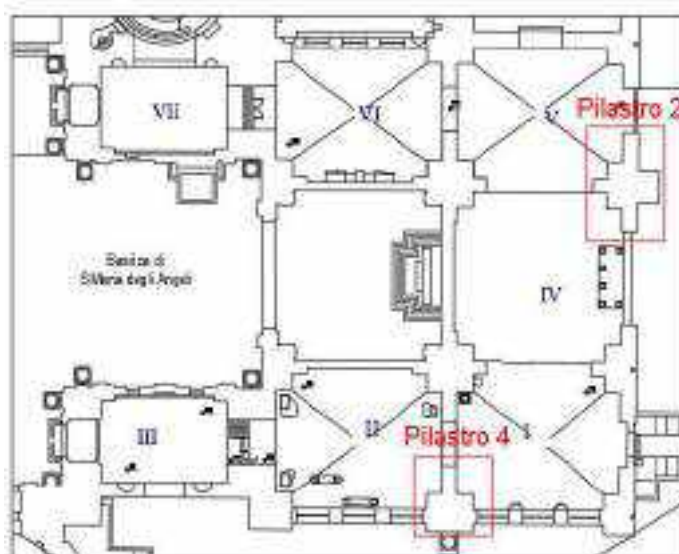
Ubicazione in planimetria dei Pilastri 2 e 4
